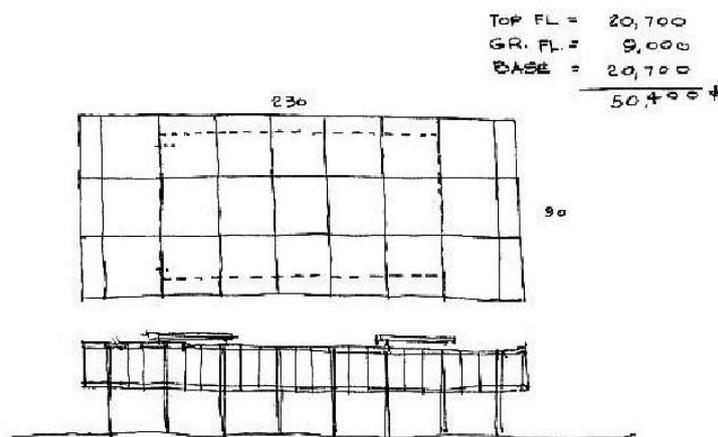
Croqui nº5, escolhido para elaboração do projeto executivo do Consulado Americano em São Paulo. Fonte: www.vitruvius.com.br
